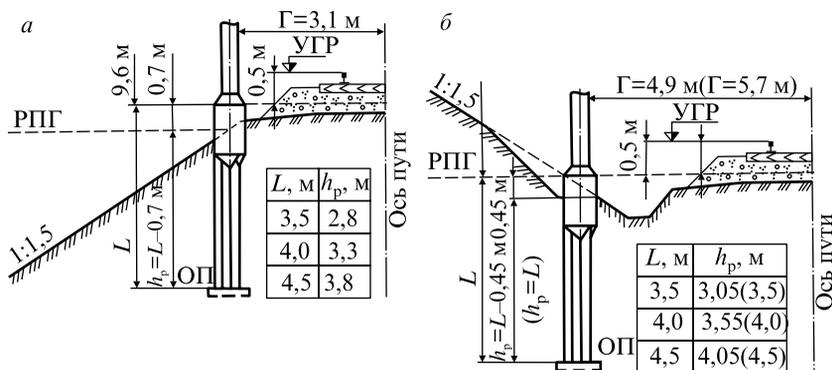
Схемы установки опор длиной 10,8 м с фундаментами ТС на насыпи (а) и в выемке (б);  $L$  — длина фундамента;  $h_p$  — глубина заложения; ОП — опорная плита
